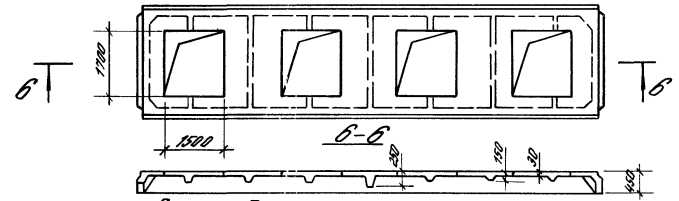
Плита типоразмера 1П12 с четырьмя проемами для зенитных фонарей
